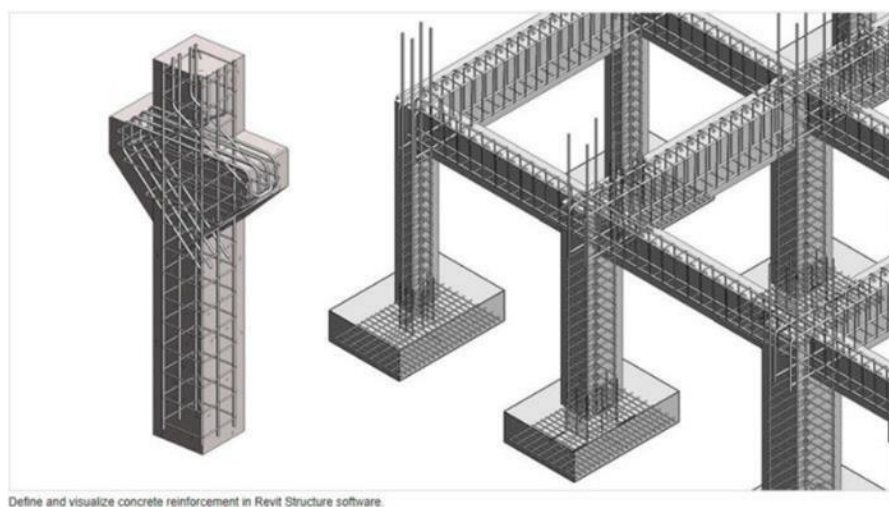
Exemplo de armaduras BIM modeladas em Revit (Autodesk)
